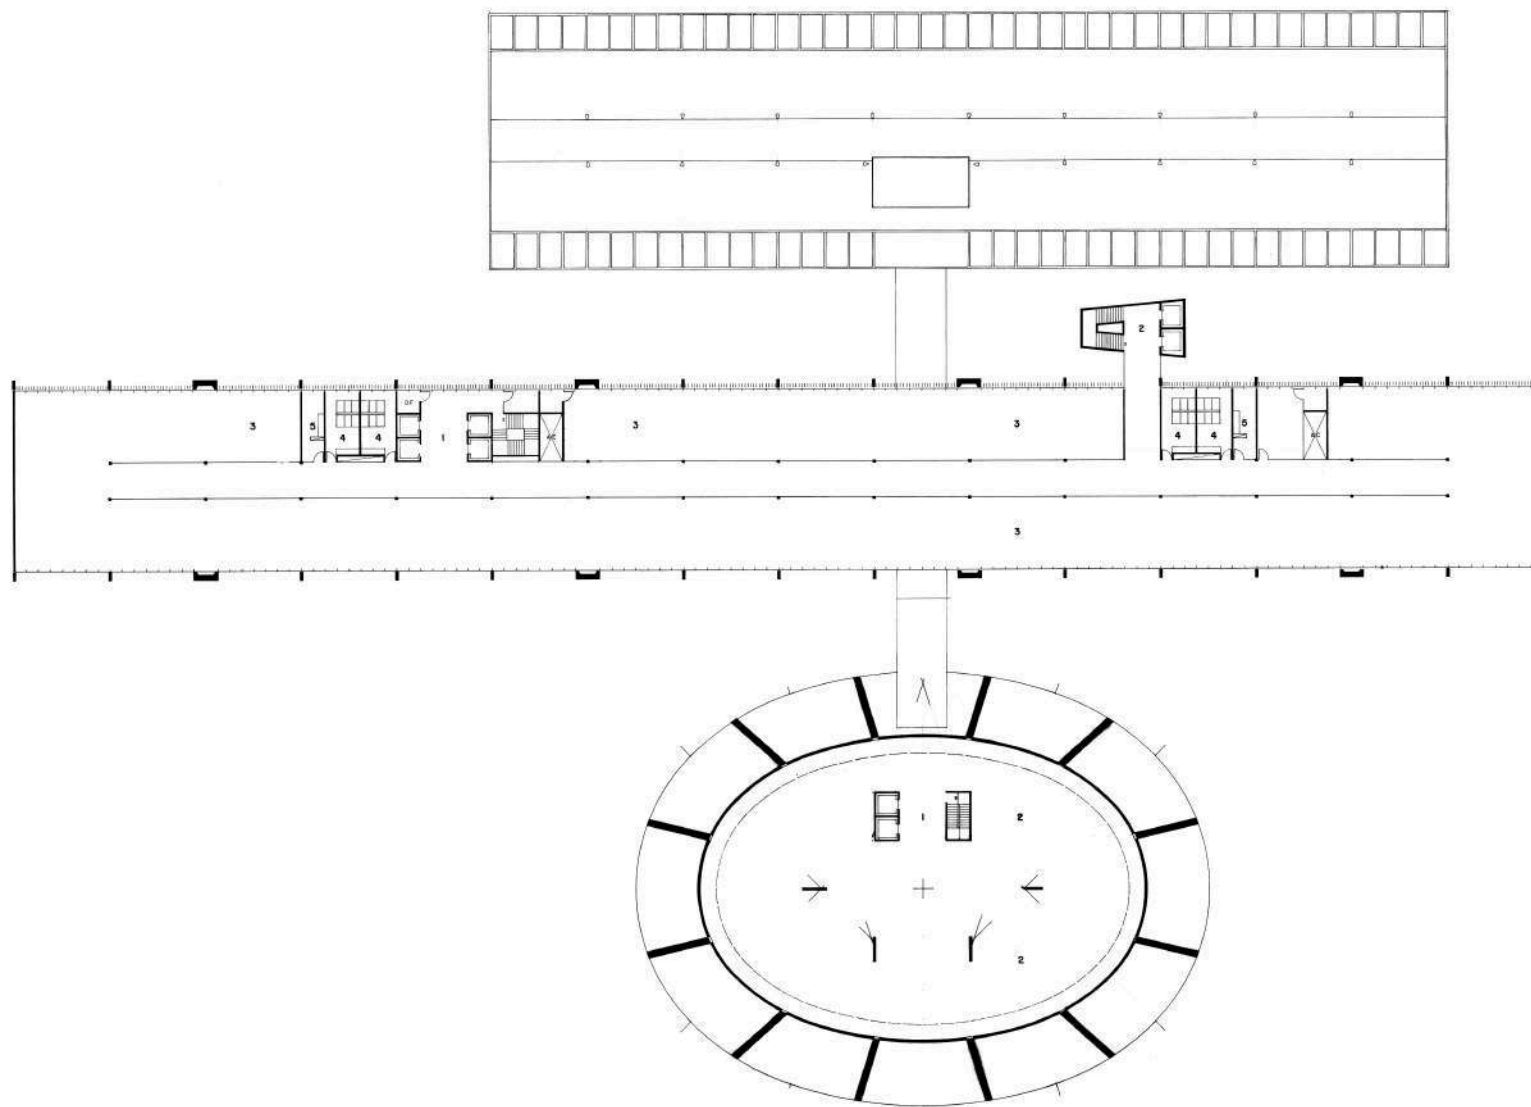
Planta do 2º. e 3º. pavimentos do Arquivo Público, 1992. Fonte: ArqPDF.
